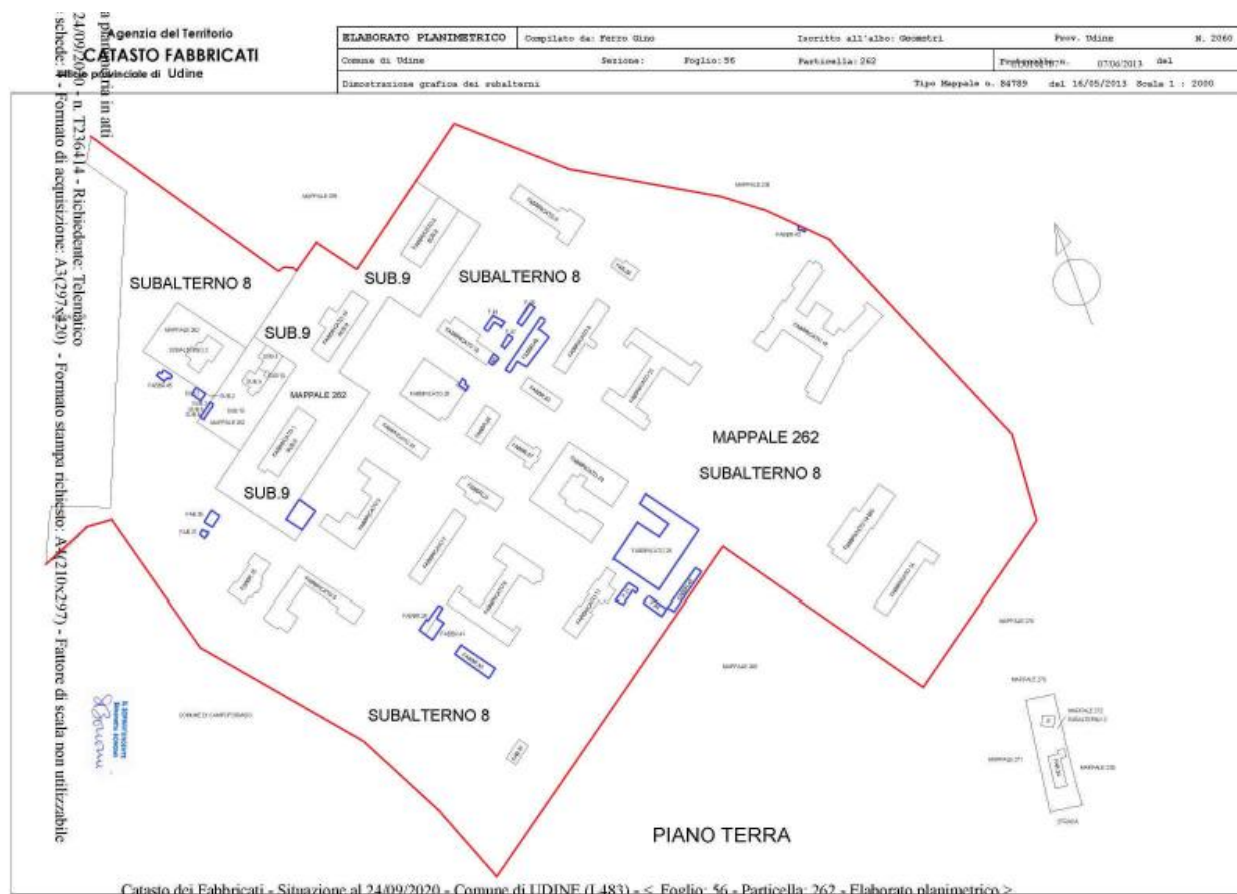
Estratto elaborato planimetrico dell'ex Ospedale Psichiatrico Sant'Osvaldo di Udine recante il perimetro dell'area sottoposta a vincolo
